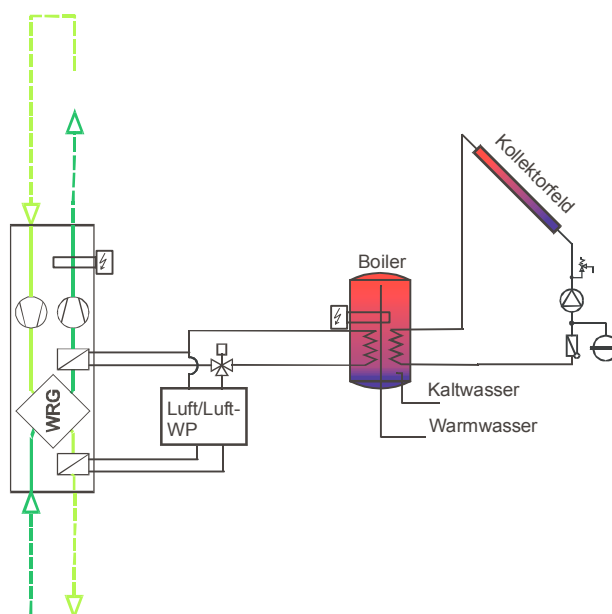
System 1 – Kleinstwärmepumpe mit Luftheizung – dezentral (Kollektorfeld und EWT empfohlen)
